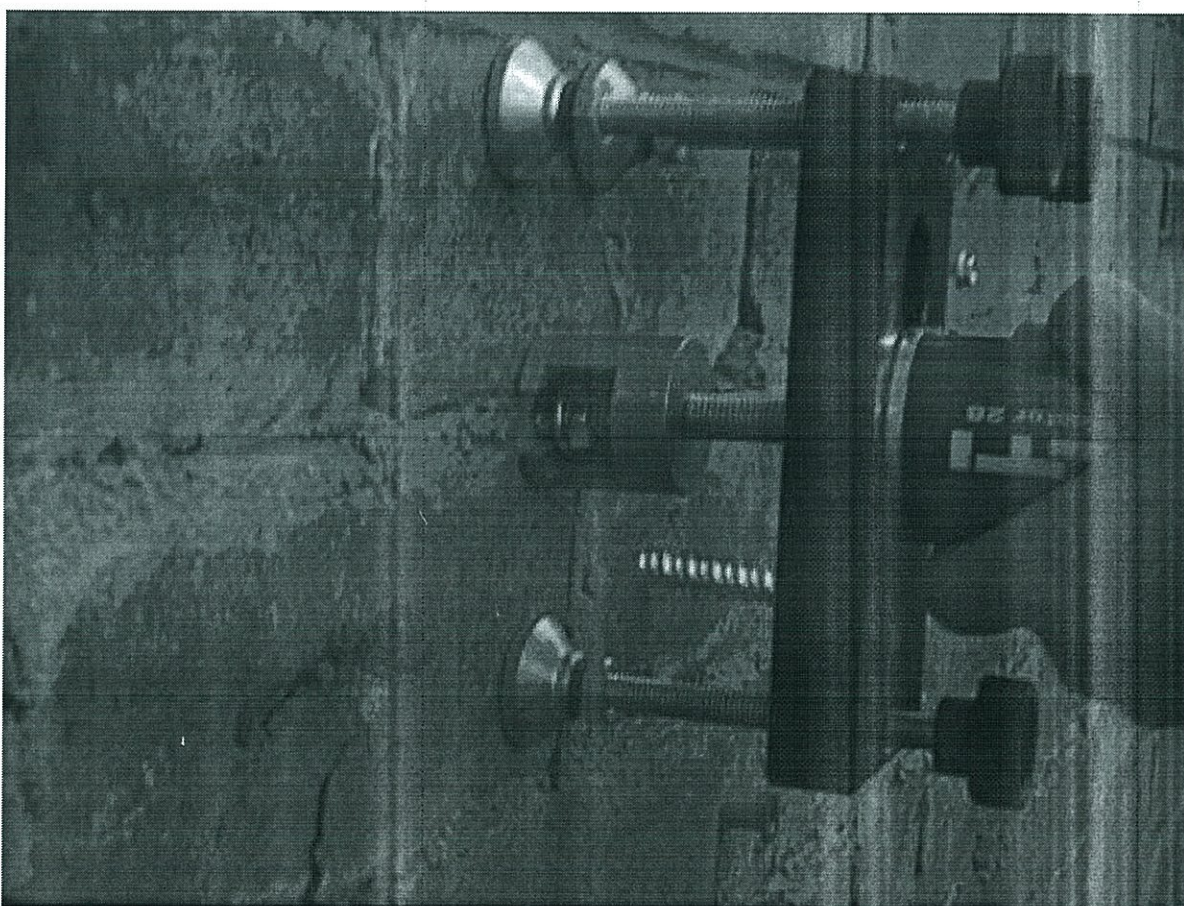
Испытание анкера марки HUS-H, закреплённого в горизонтальный растворный шов кладки из вибропрессованного бетонного кирпича
